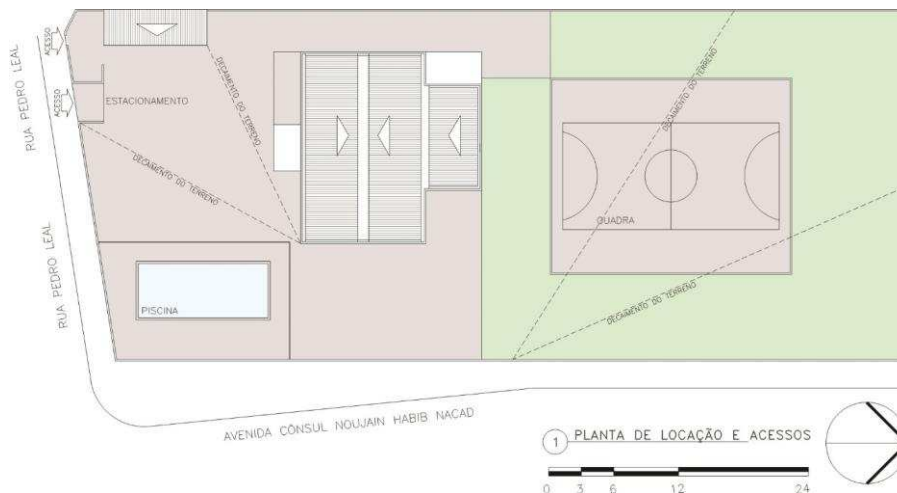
Planta de localização e cobertura da situação atual (Fonte: Arquivo pessoal)
